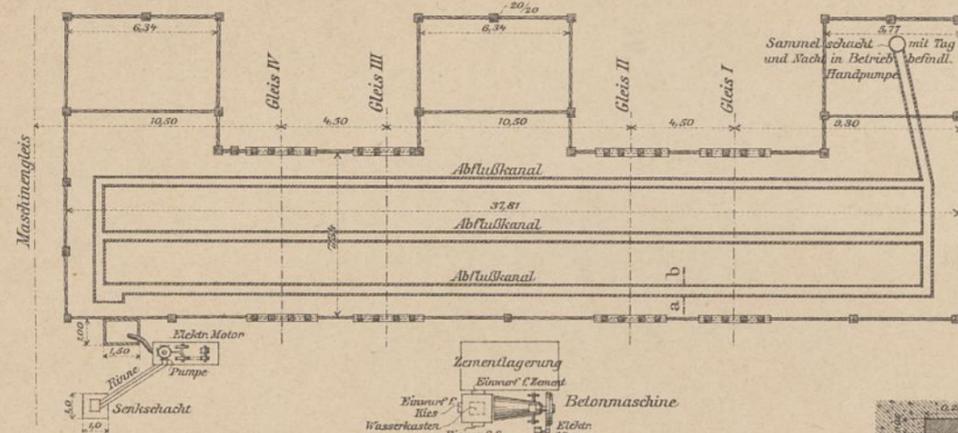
Kanäle zur Haltung des Grundwassers während der Bauausführung und Anordnung der Pumpen und Betonmaschine.
